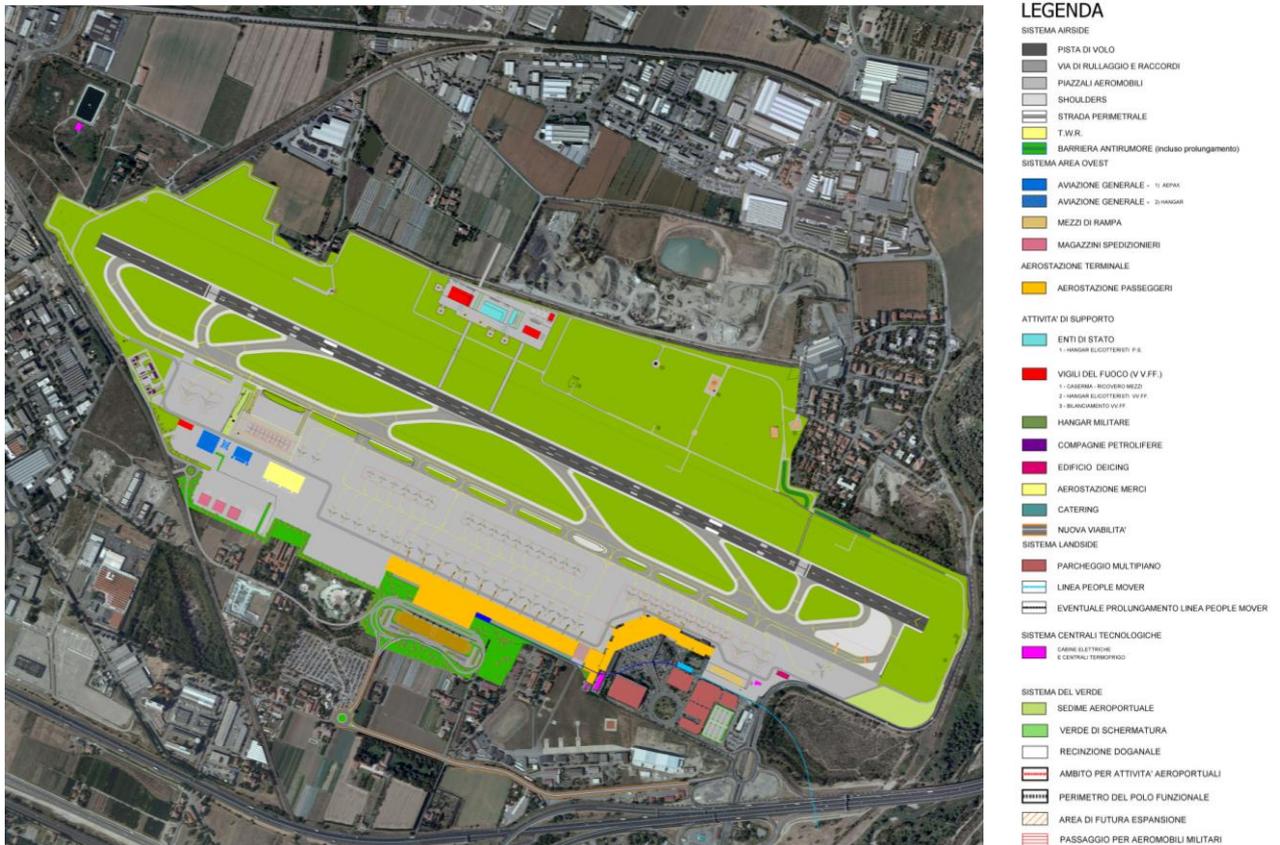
Planimetria generale assetto infrastrutturale aeroportuale al 2023
